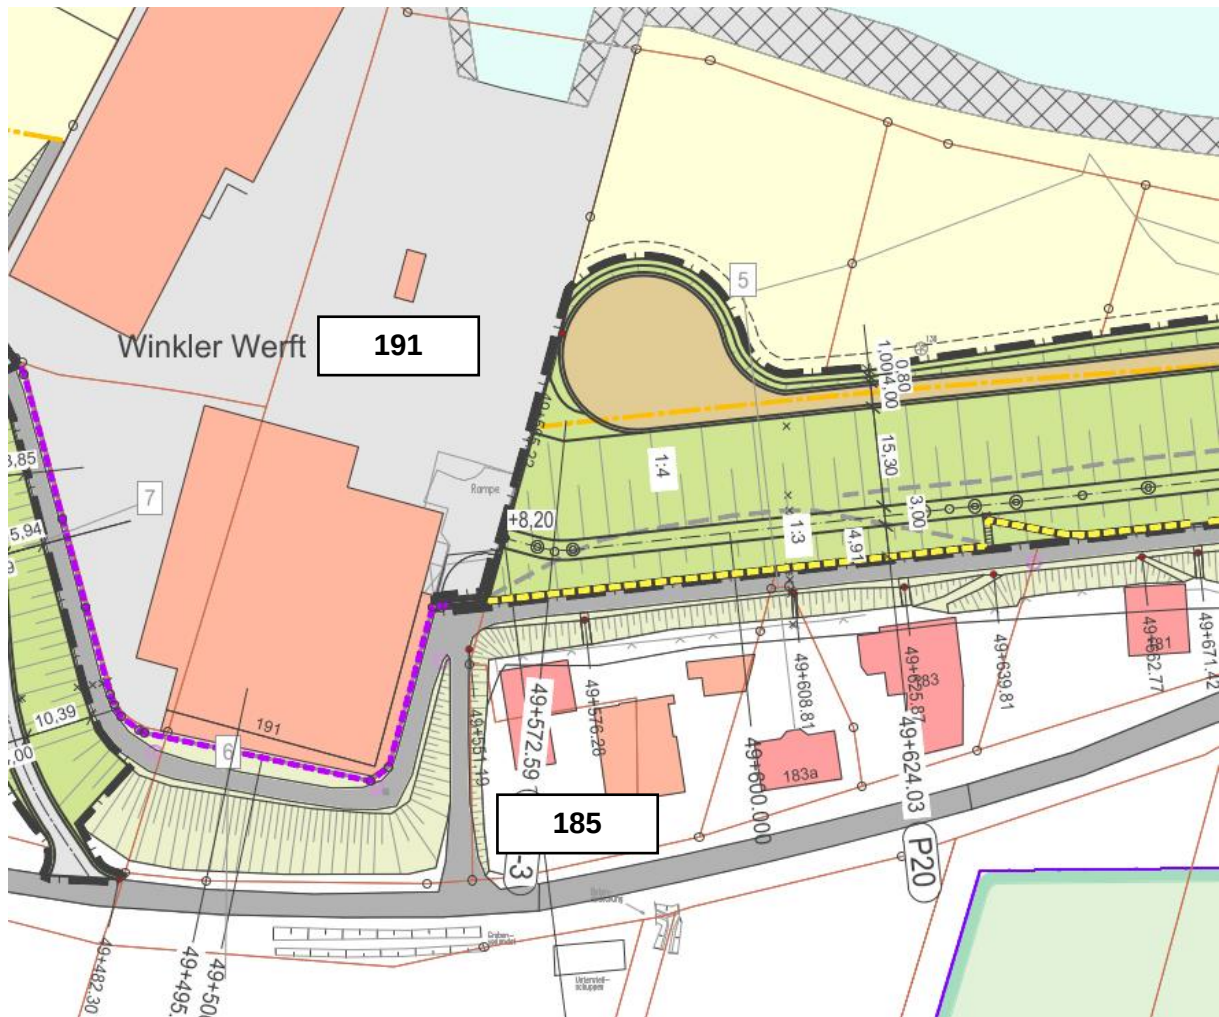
Lage der Grundstücke Lesumbröcker Landstraße 185 / 191
